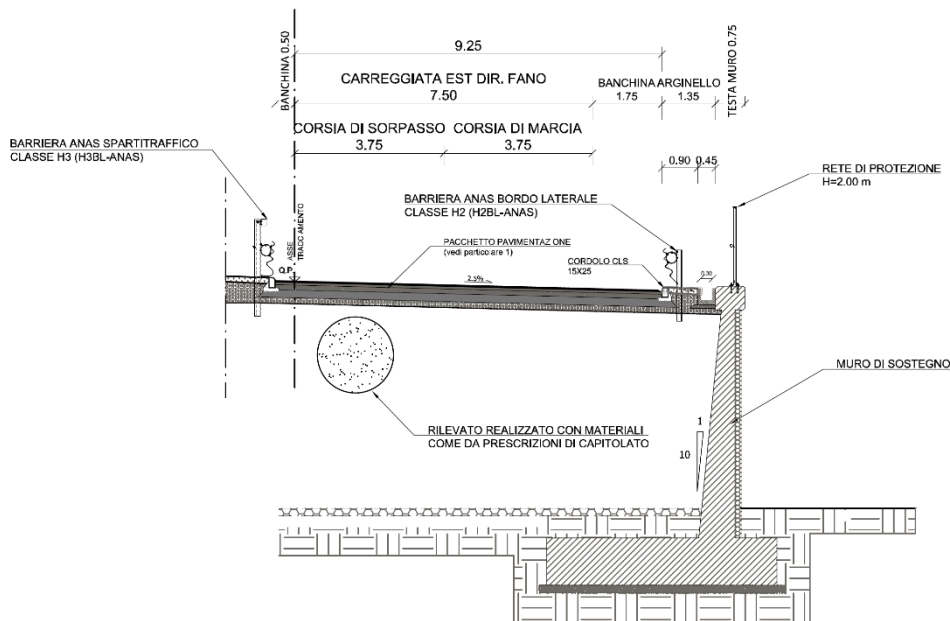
Sezione tipo in rilevato – Muro di sostegno con canaletta idraulica
